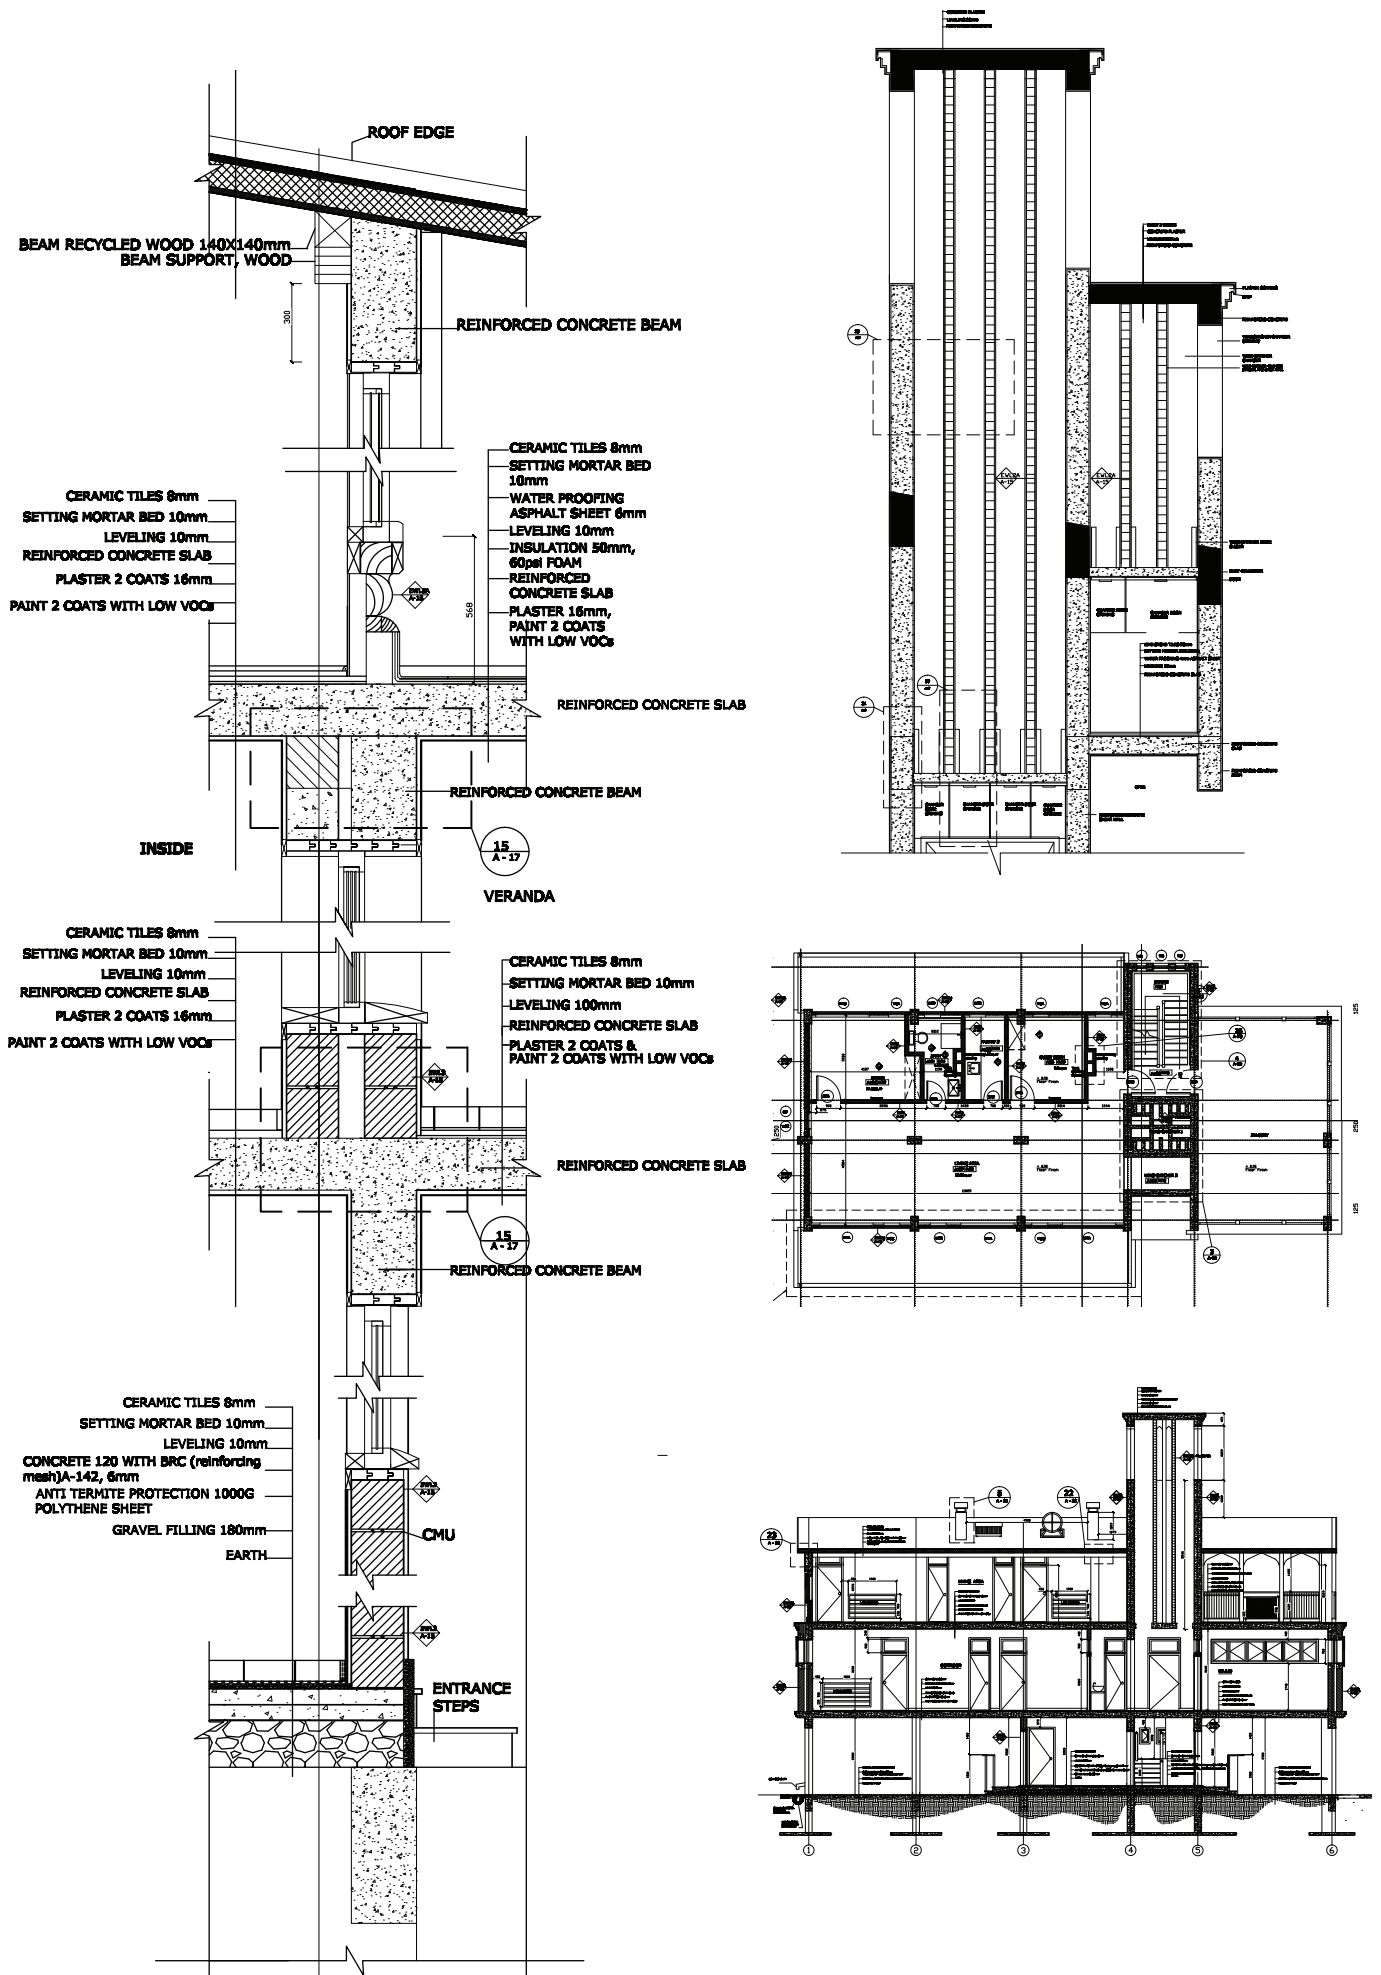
Coupe du mur et de la tour à vent de la maison DHO. Source: DHO team
